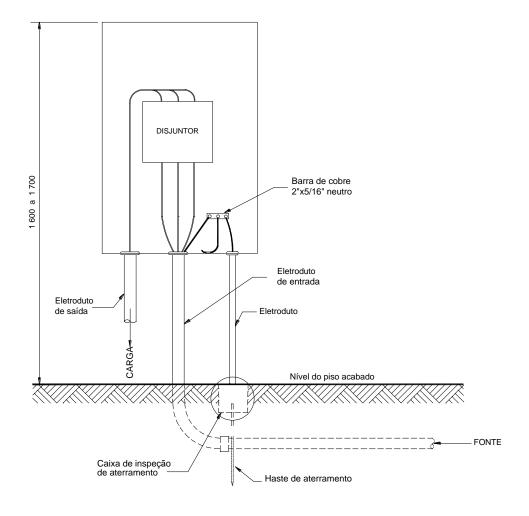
Instalação da proteção da caixa seccionadora tipo T
